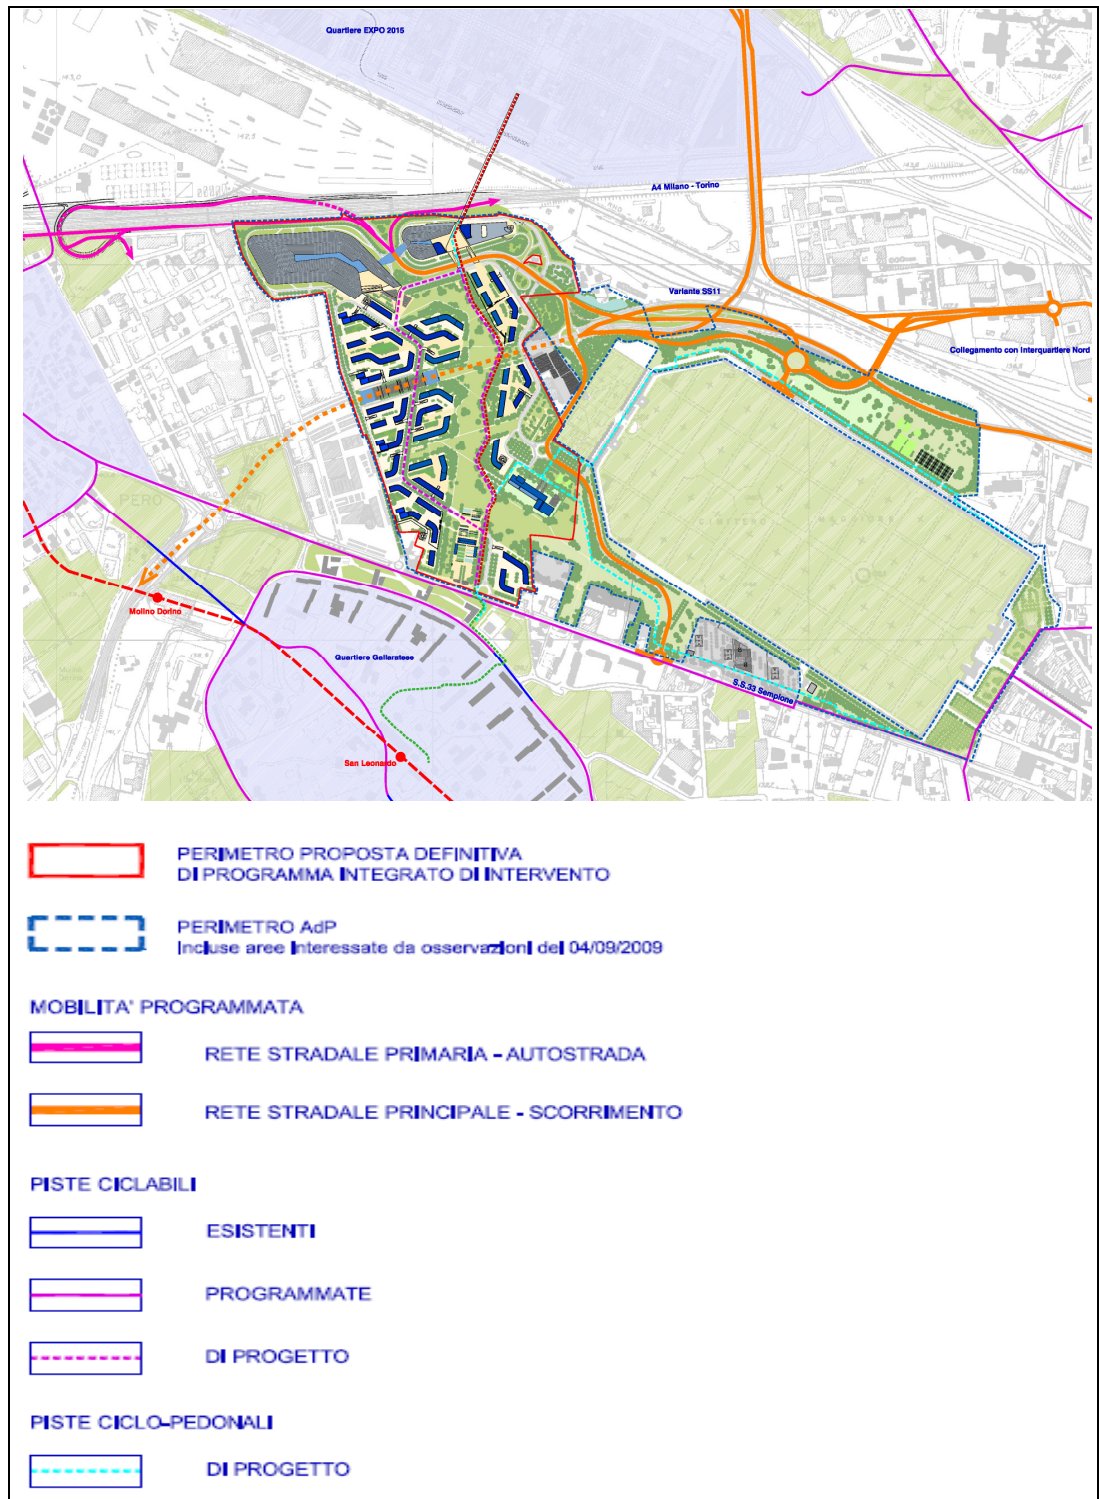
planimetria dell'AdP "Cascina Merlata" (estratto Tav. 4.1 PII – Planimetria nel contesto urbano)
